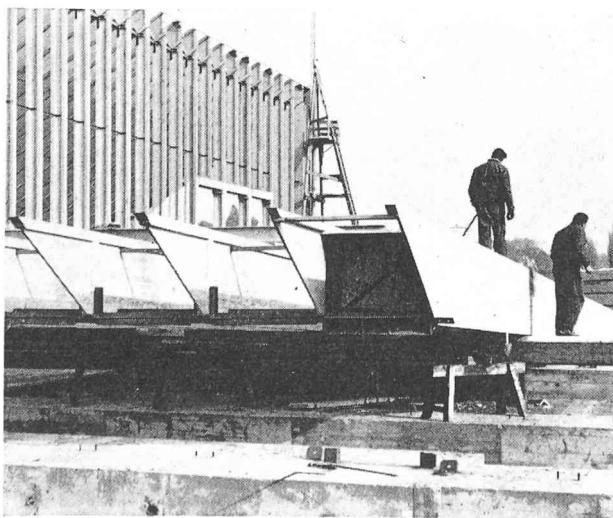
Diaphragme de raidissement d'une poutre caisson.
